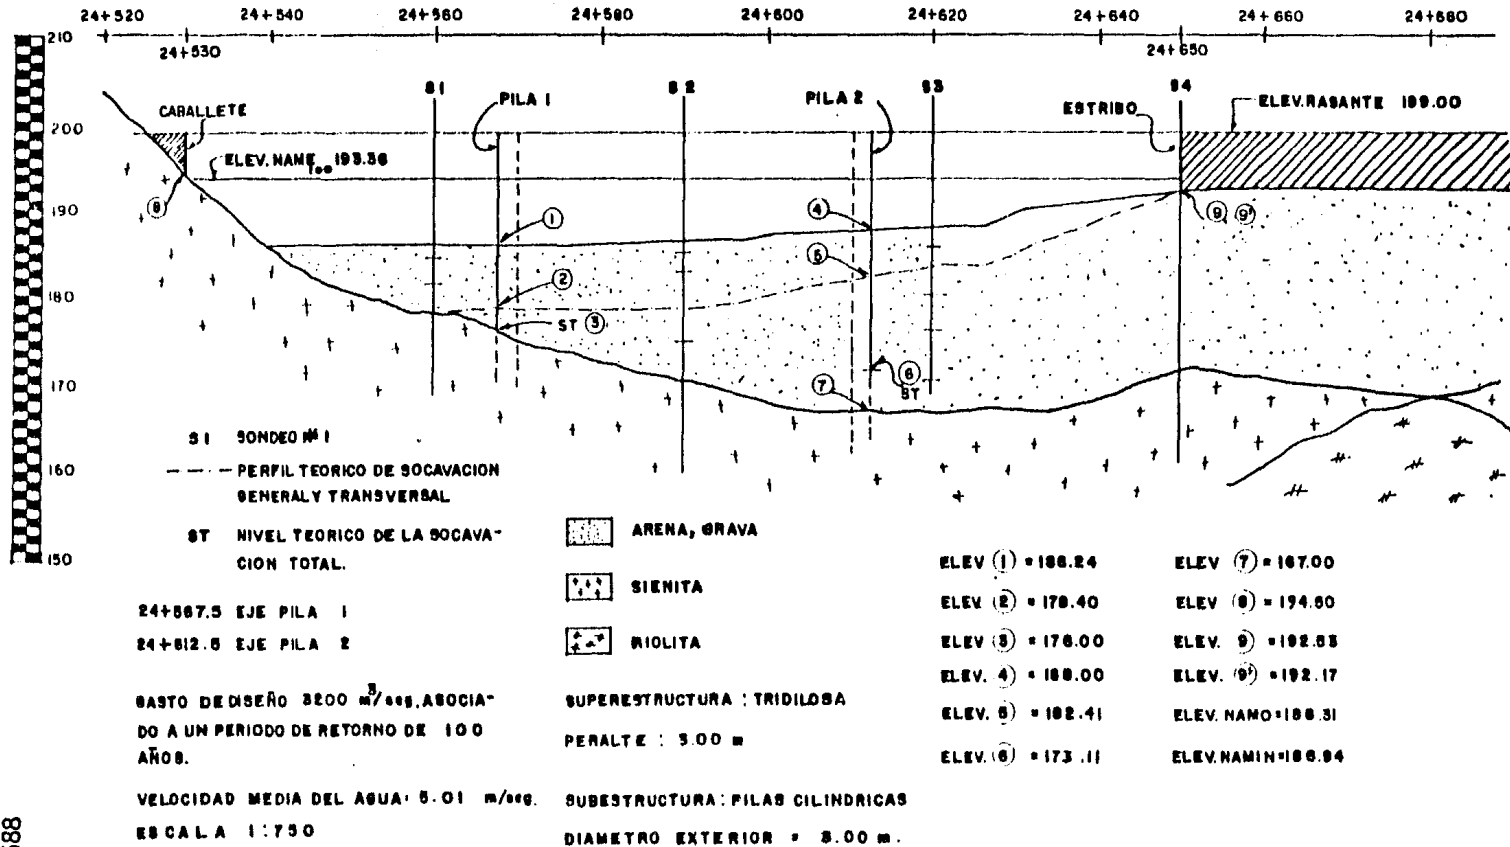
PUENTE CRUCE RIO TAMAZULA II. POSICION DEFINITIVA PILAS.
